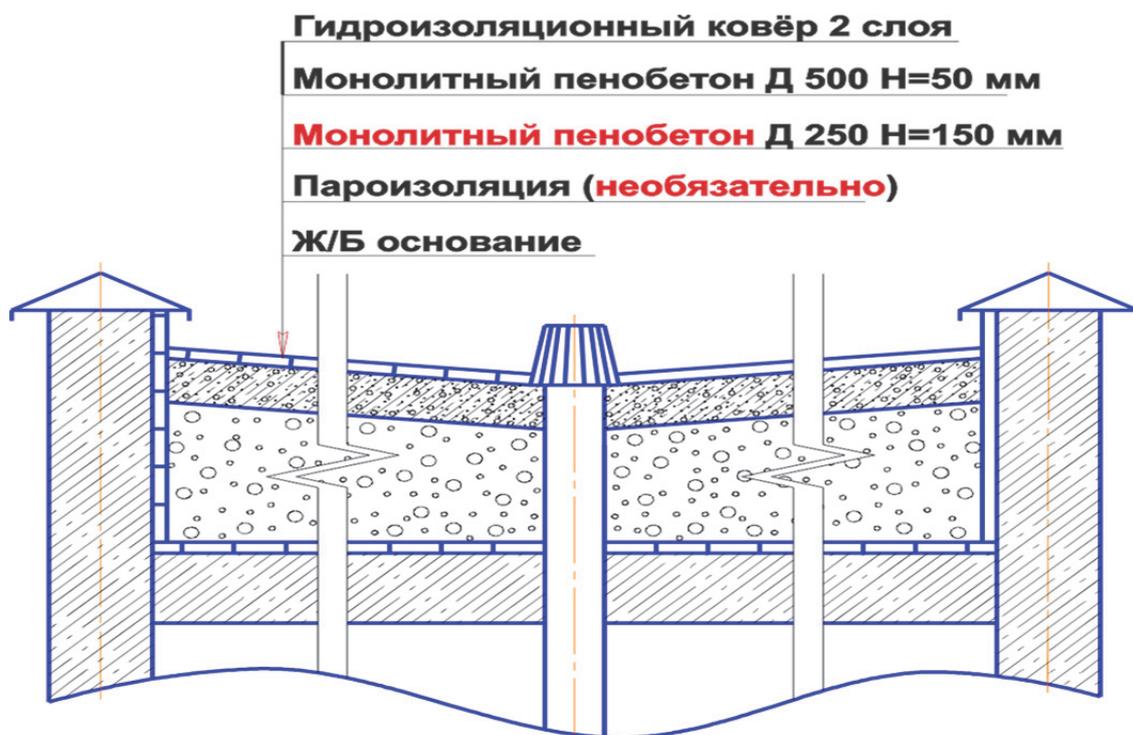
Устройство плоской кровли с применением монолитного Пенобетона
